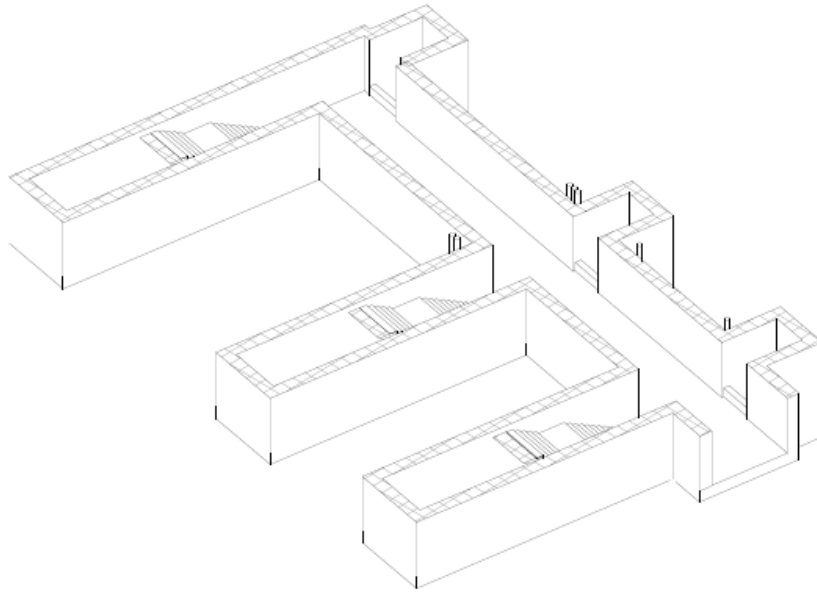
Nuovo sottopasso di stazione SL02 – Spaccato assonometrico
